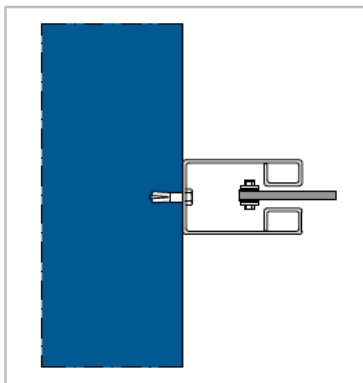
Монтаж на управляваща конструкция на вертикална стена/конструкция
